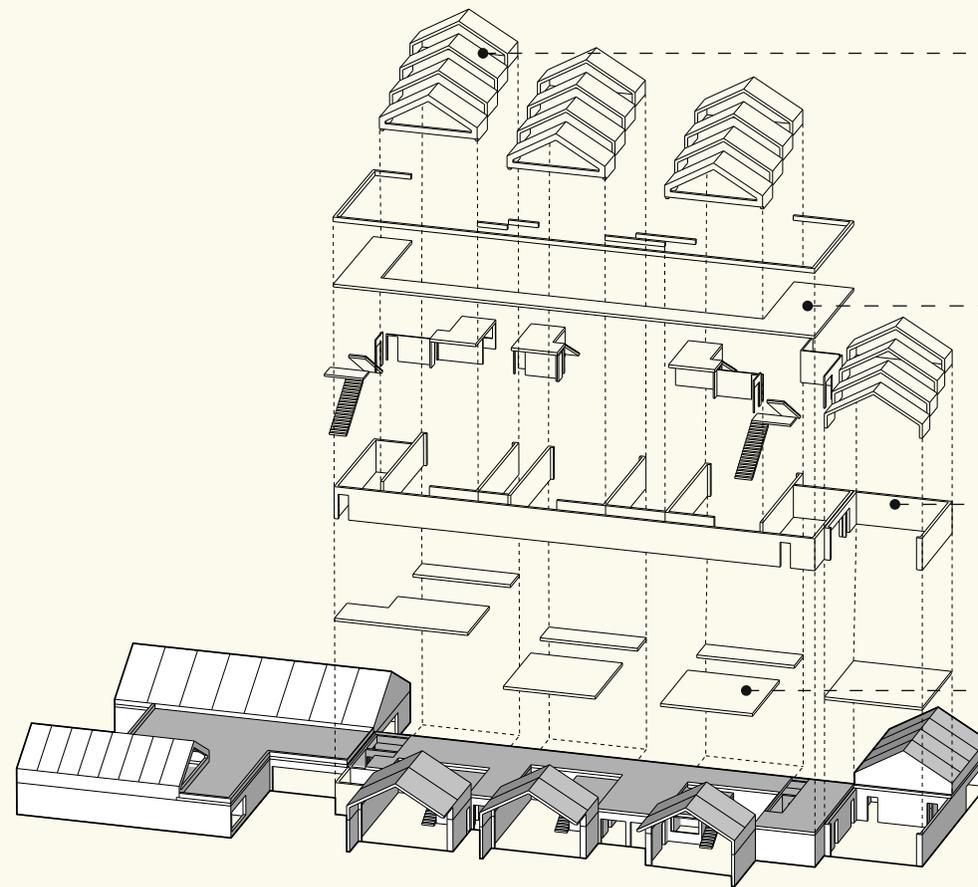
, axonometrische Darstellung – tragendes Gerüst des eingeschossigen Ausbaus
